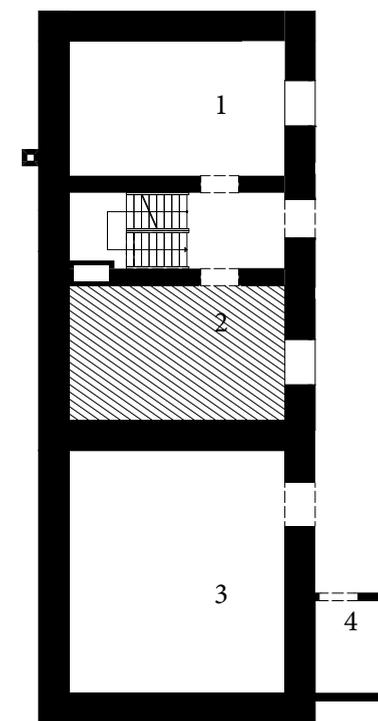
Grundriss Erdgeschoss 2. Bauphase 1:200
